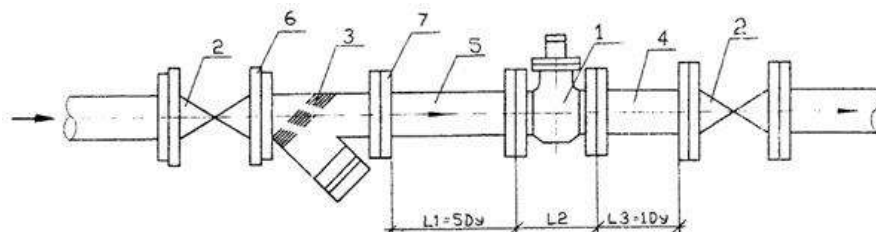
Схема монтажа: 1 - счетчик воды; 2 - задвижка; 3 - фильтр магнитный; 4 - патрубок; 5 - патрубок; 6 - прокладка; 7 - фланец по ГОСТ 12815.
